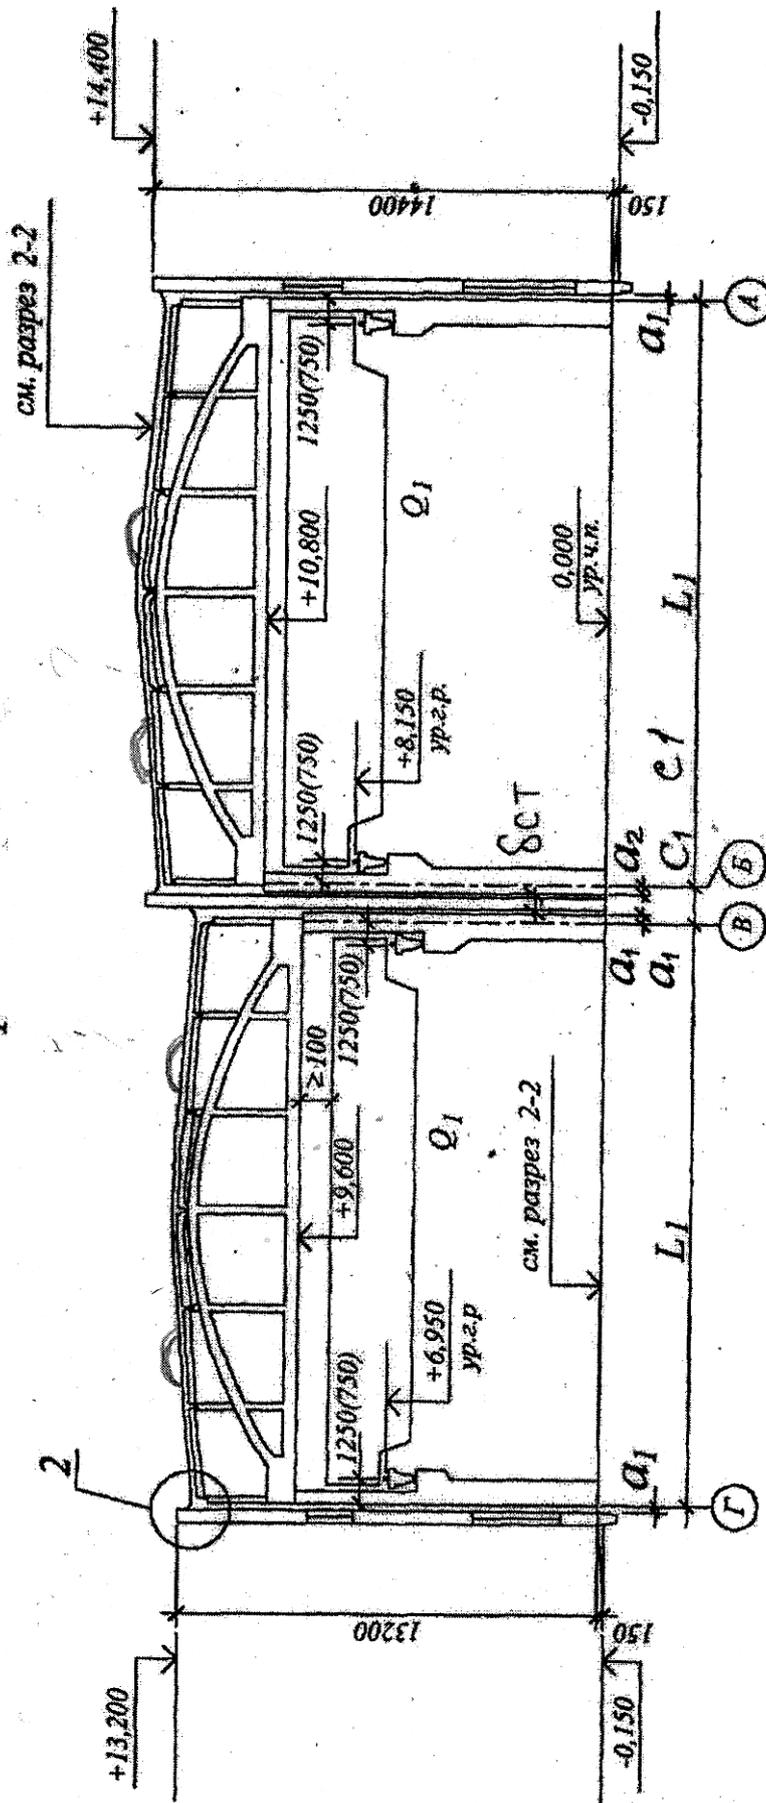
Продольный разрез производственного здания с примыкающим к нему пентенликляным пролетом
